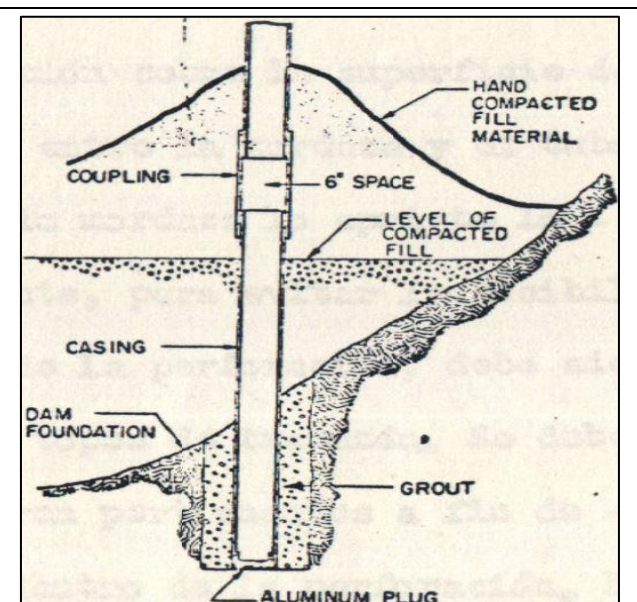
d Colocación de tubería en puntos en en las que aún no se construía terraplén.
